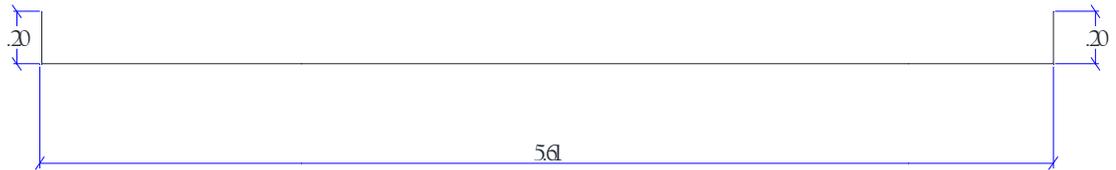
ACERO DE REFUERZO DEL VÁSTAGO DEL MURO
